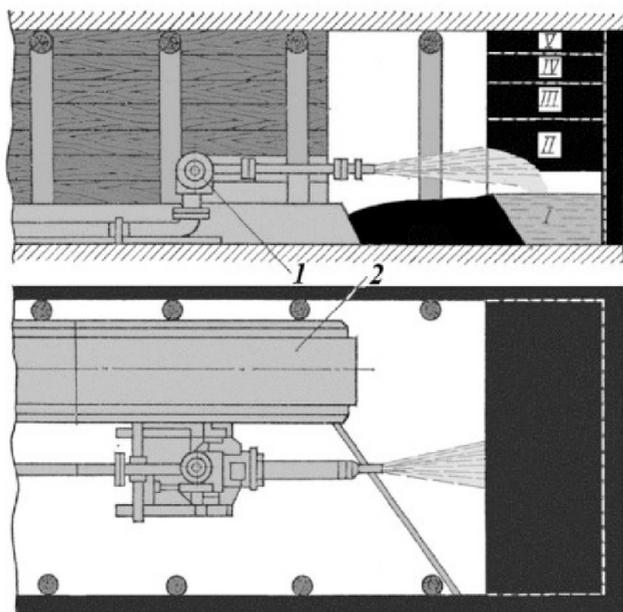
Схема проведения выработки при отбойке угля гидромонитором:
